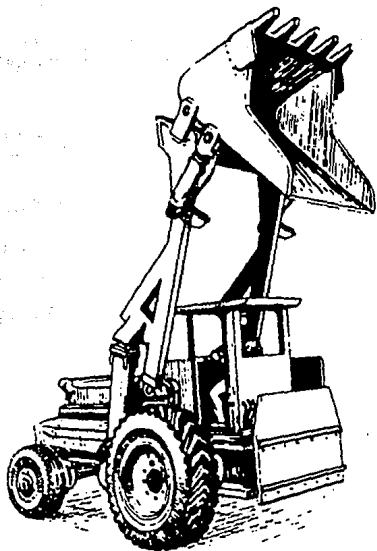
Máquina de descarga trasera cuyo cucharón es accionado hidráulicamente.
